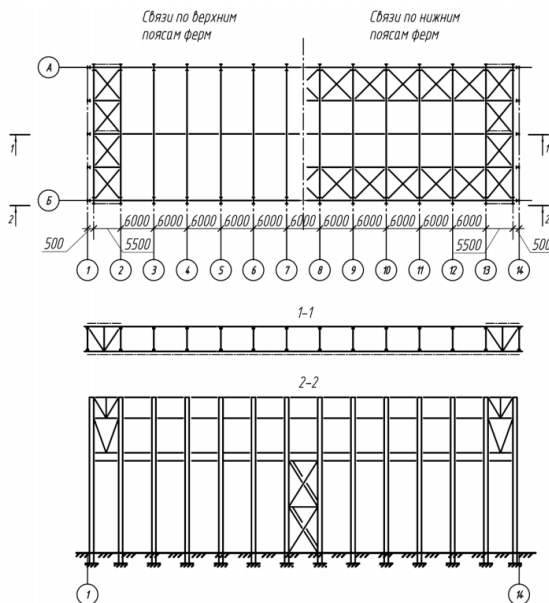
Расположение связей жесткости металлического каркаса здания
